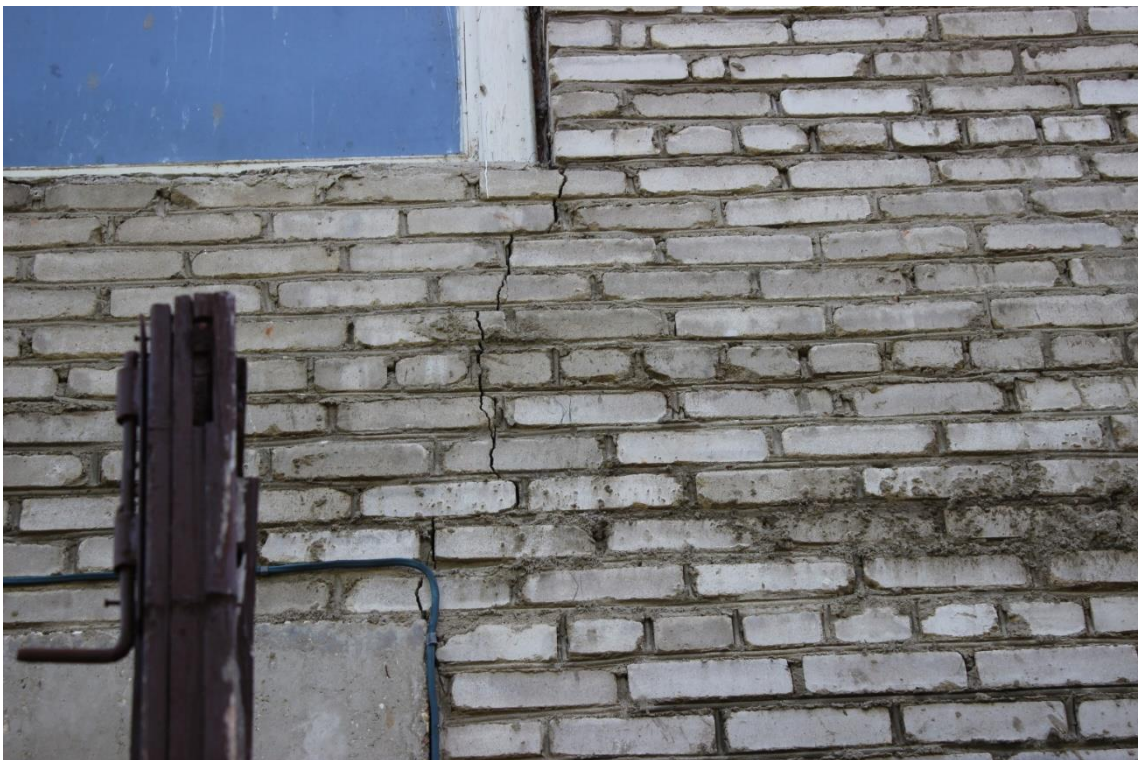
Сквозная трещина в наружной стене по оси «Д»
